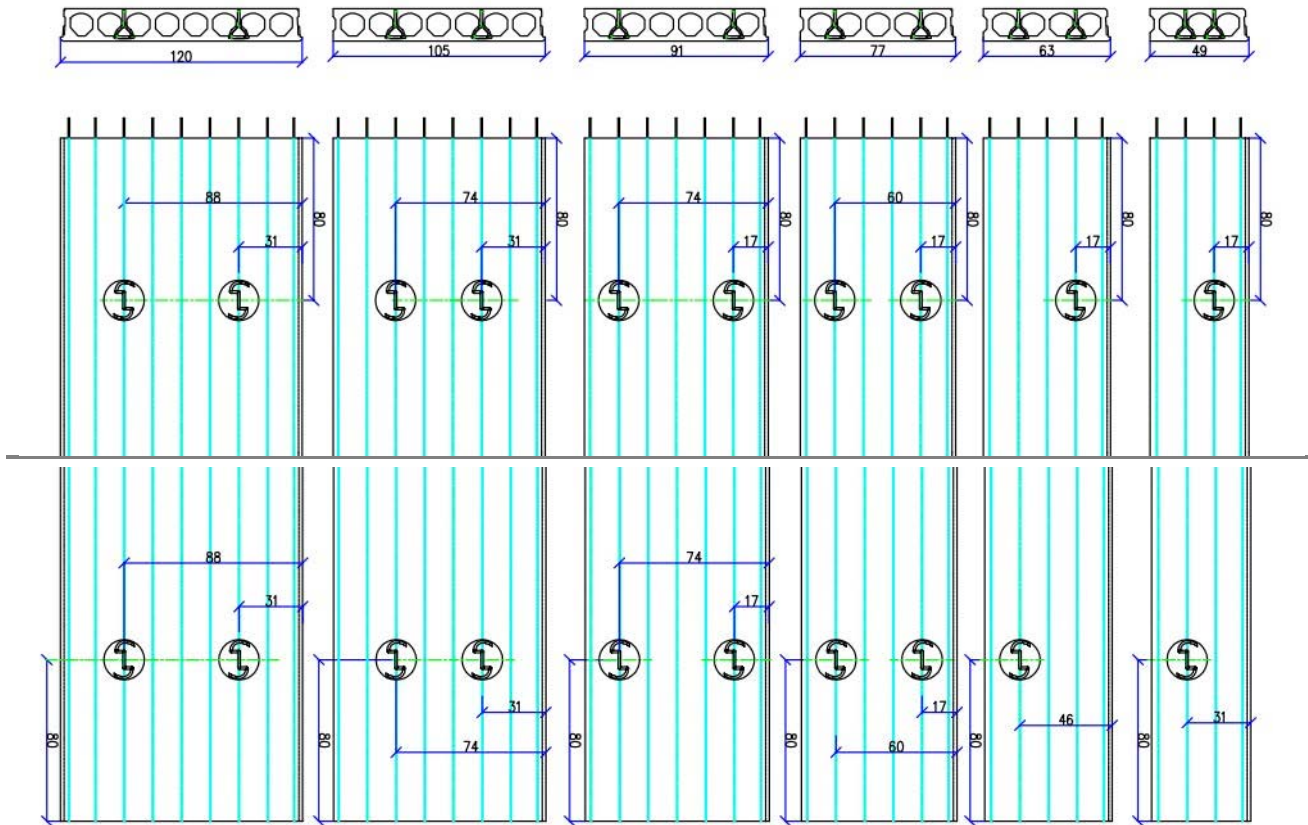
Position des boucles sur dalles DSL 1600 et DSL 16B0
